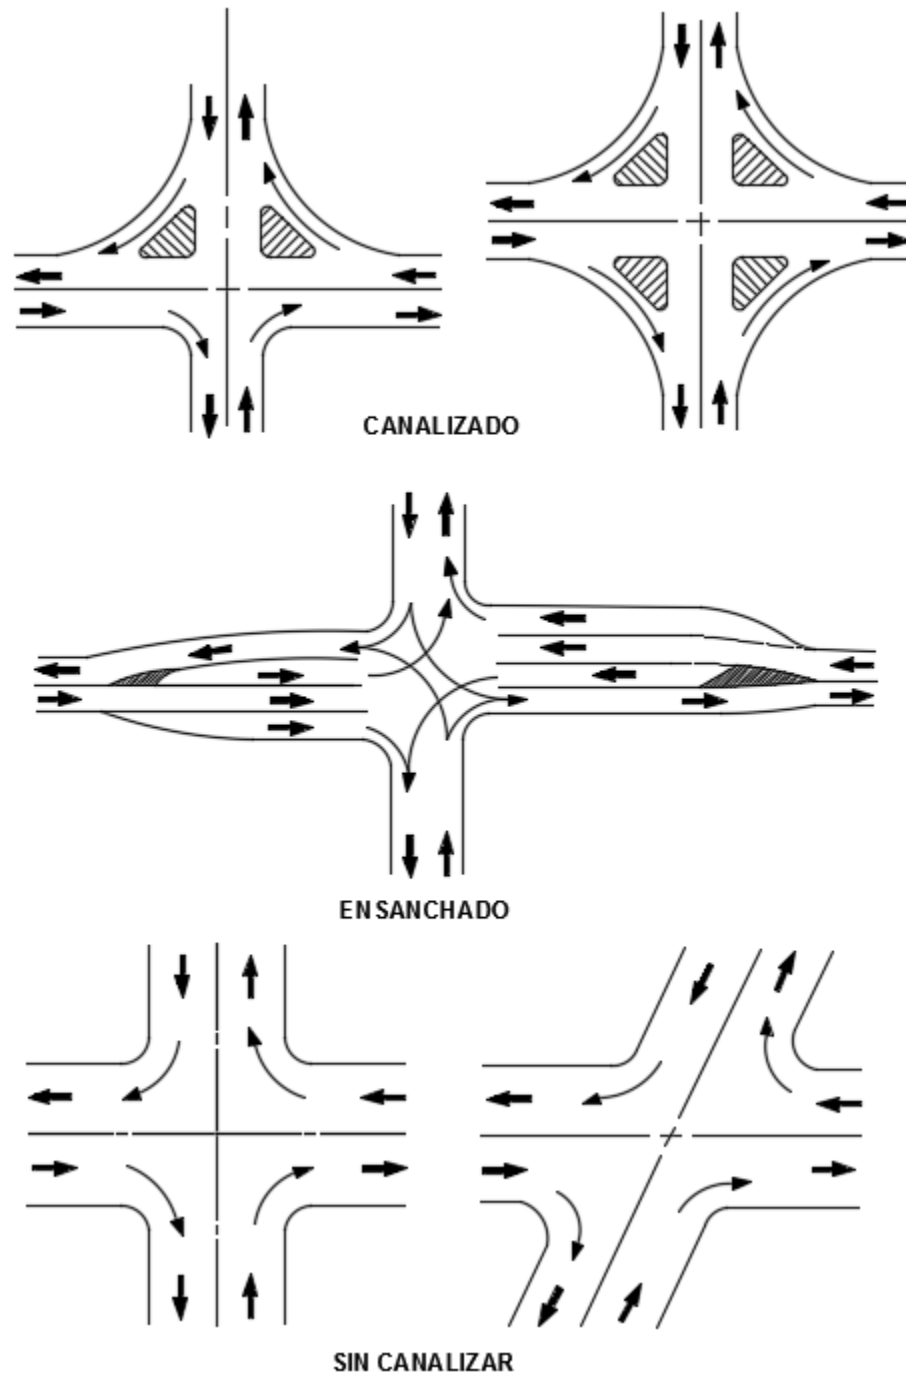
Tipos generales de intersecciones, de cuatro ramas
